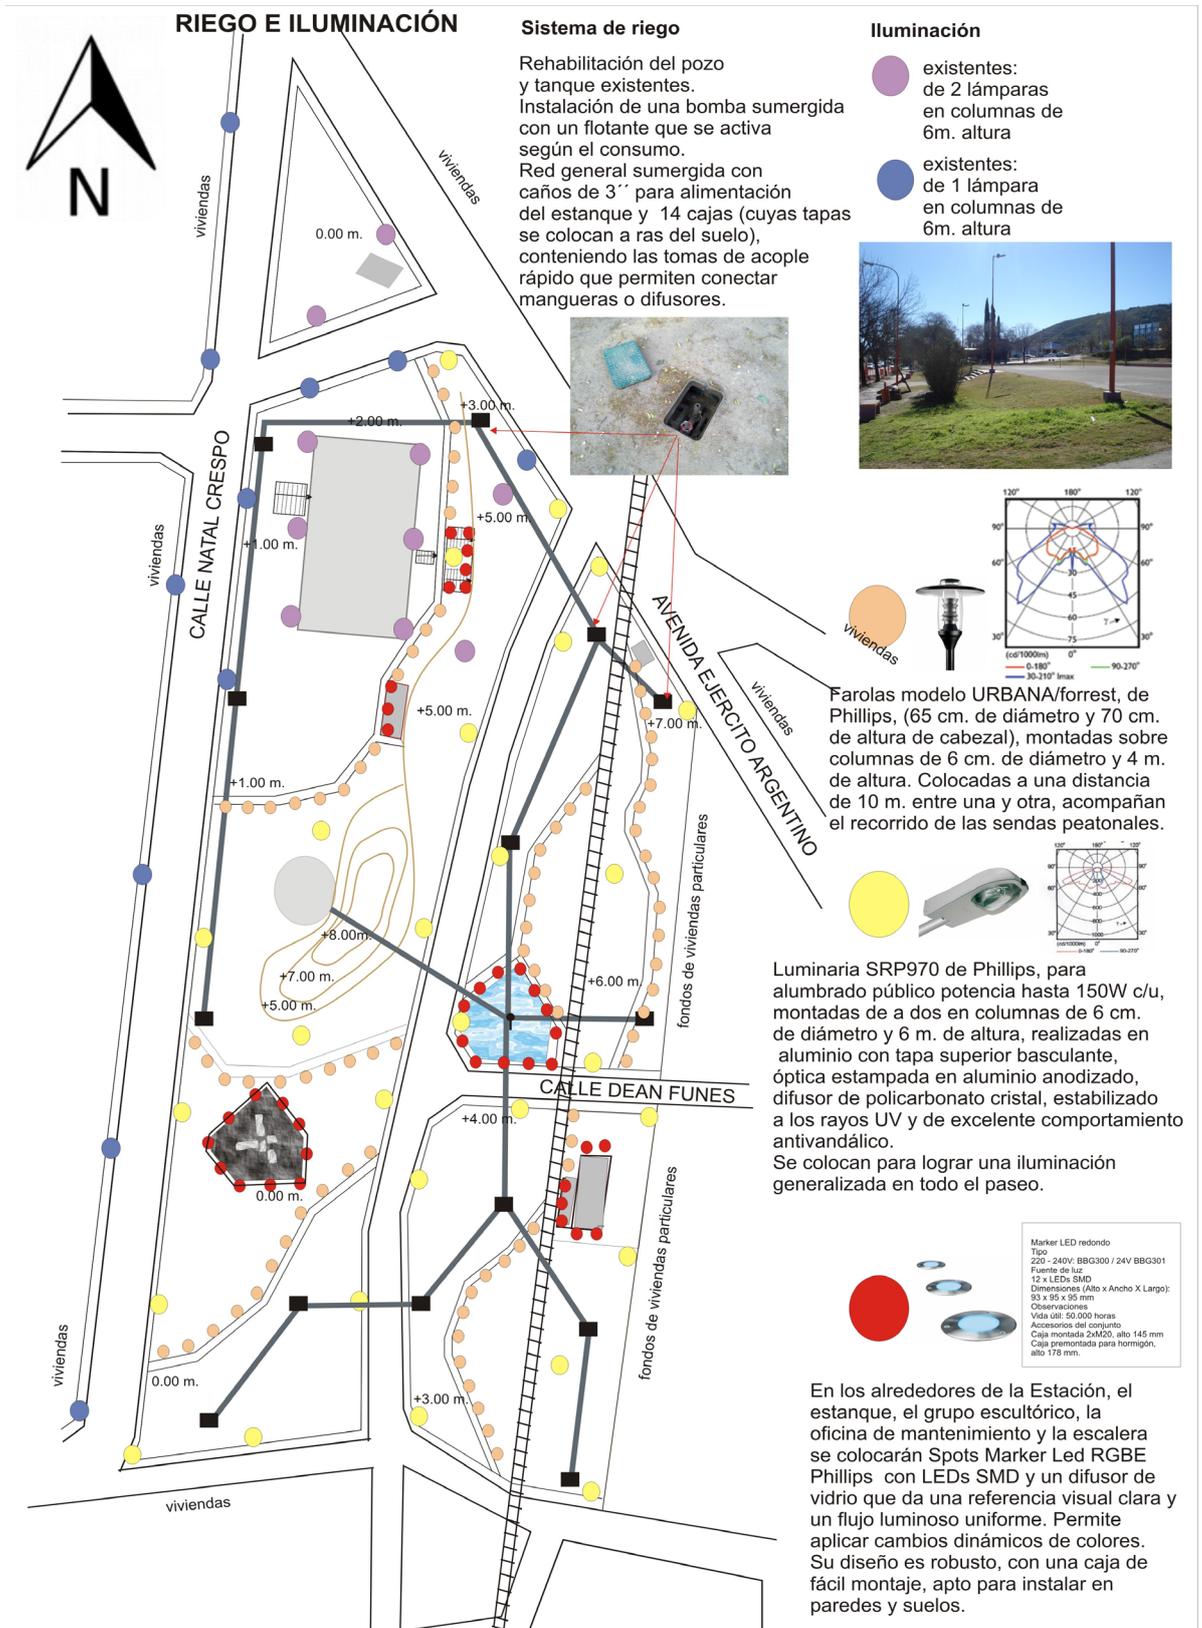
Planta de riego e iluminación. Fuente: Elaboración propia.
